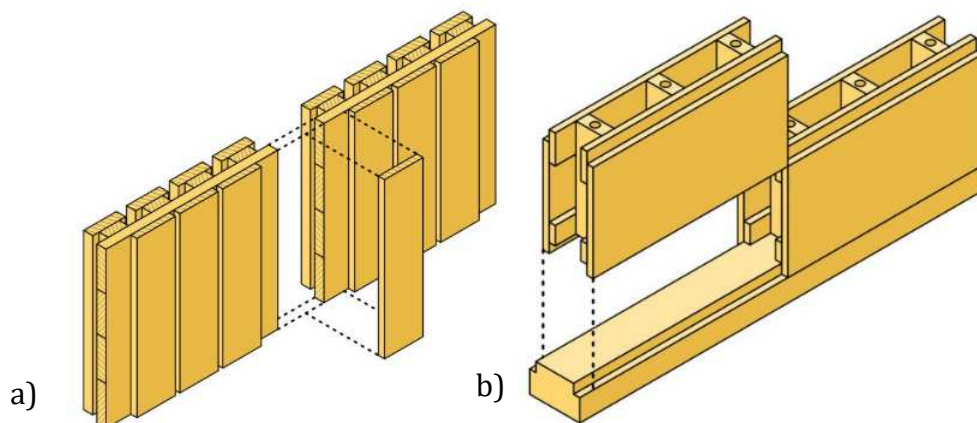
Konstrukce z masivního dřeva plného průřezu [6]
